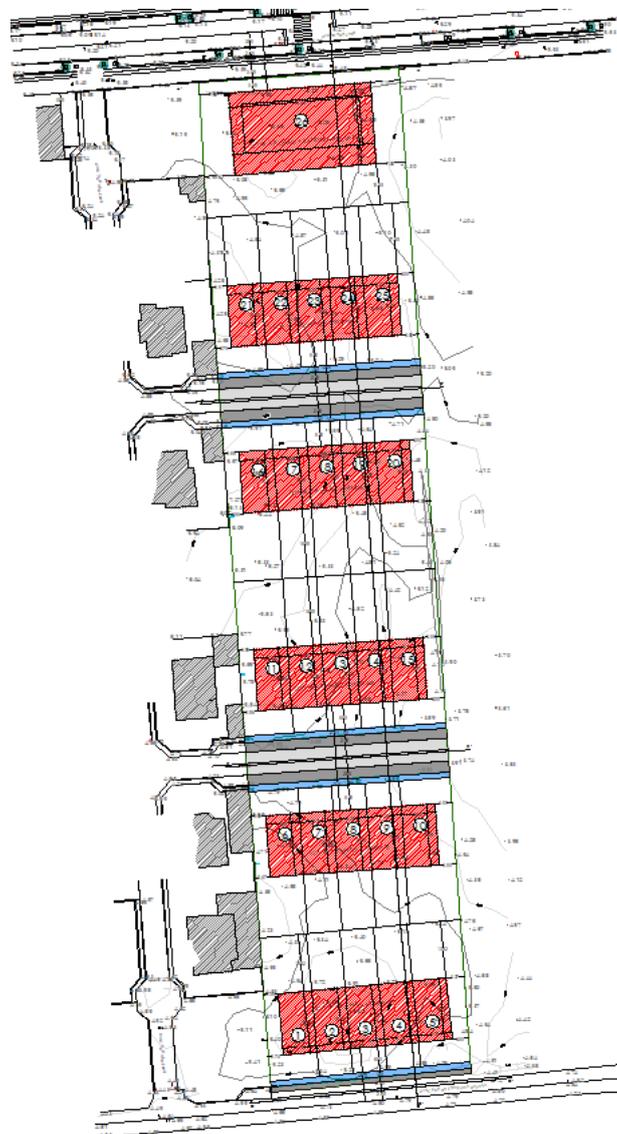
Planta Síntese (Processo n.º 515/2023)
